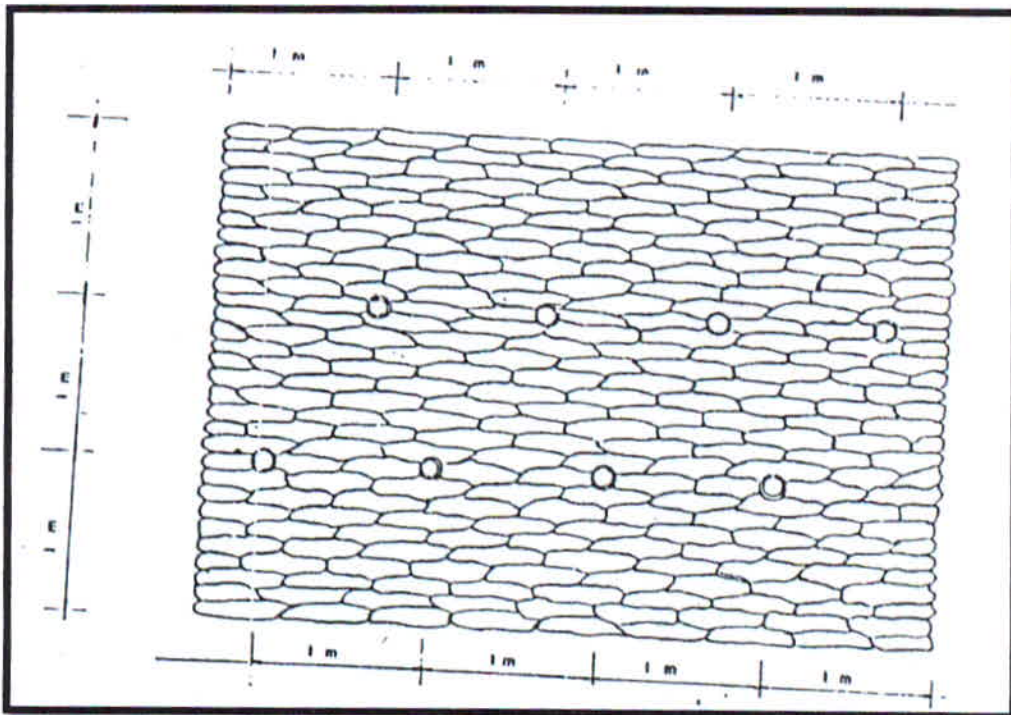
Arrumação dos sacos de solo cimento (Fonte: Notas de aula da Universidade Federal de Minas Gerais - UFMG - Movimento de Terra - Rip-Rap).
